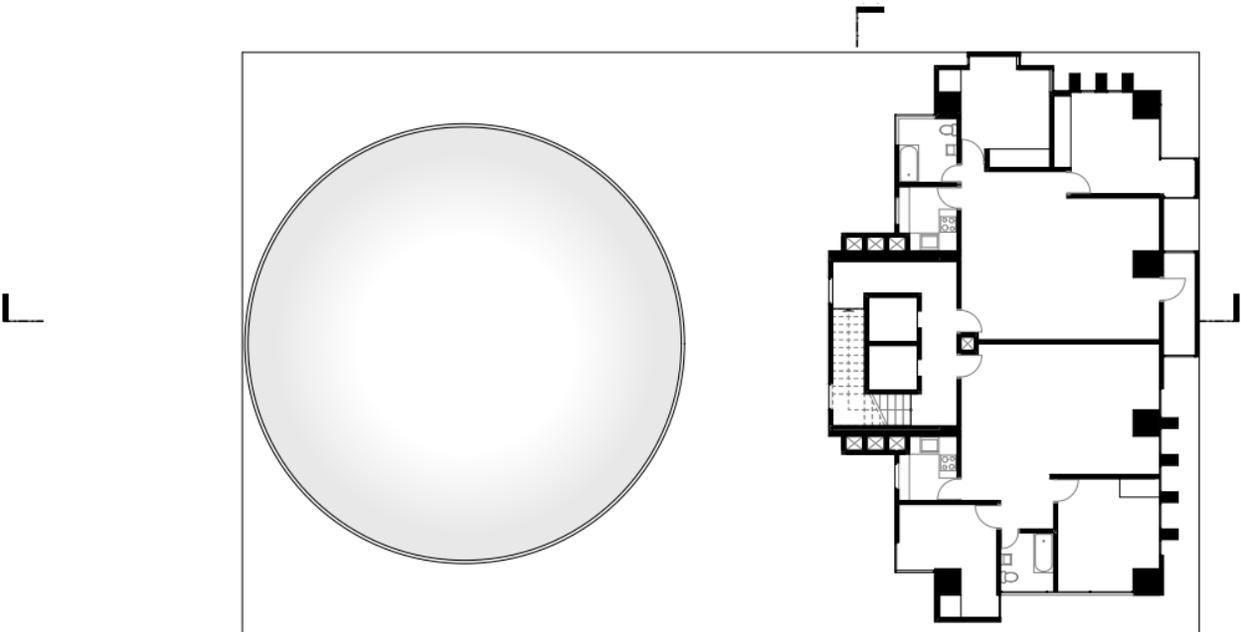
Planta alta planificada N+30.50. Fuente: Tesistas.
